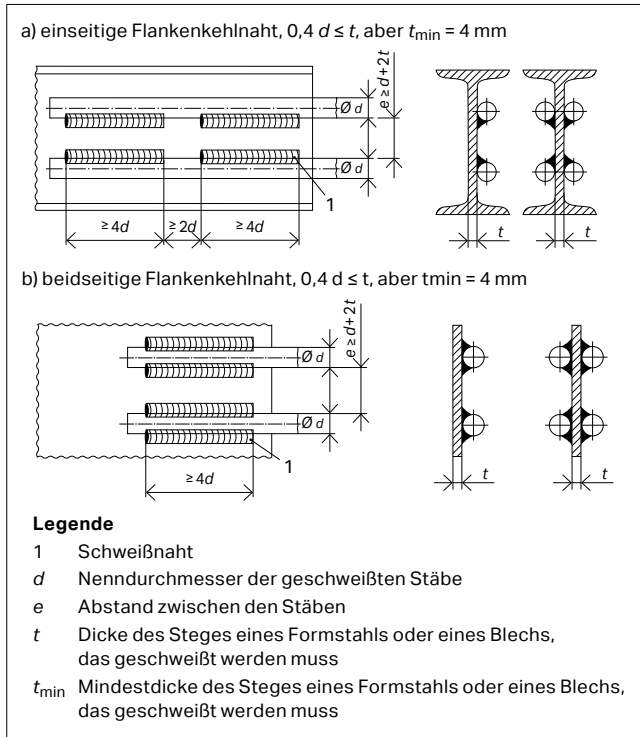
Geschweißte Flankenkehlnaht nach Kap. 6.6.2.1 – Bild 6
